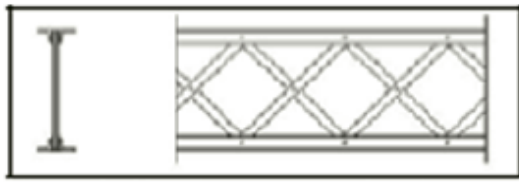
k Esquemas tipo forjado vigas de madera y vigas metálicas
